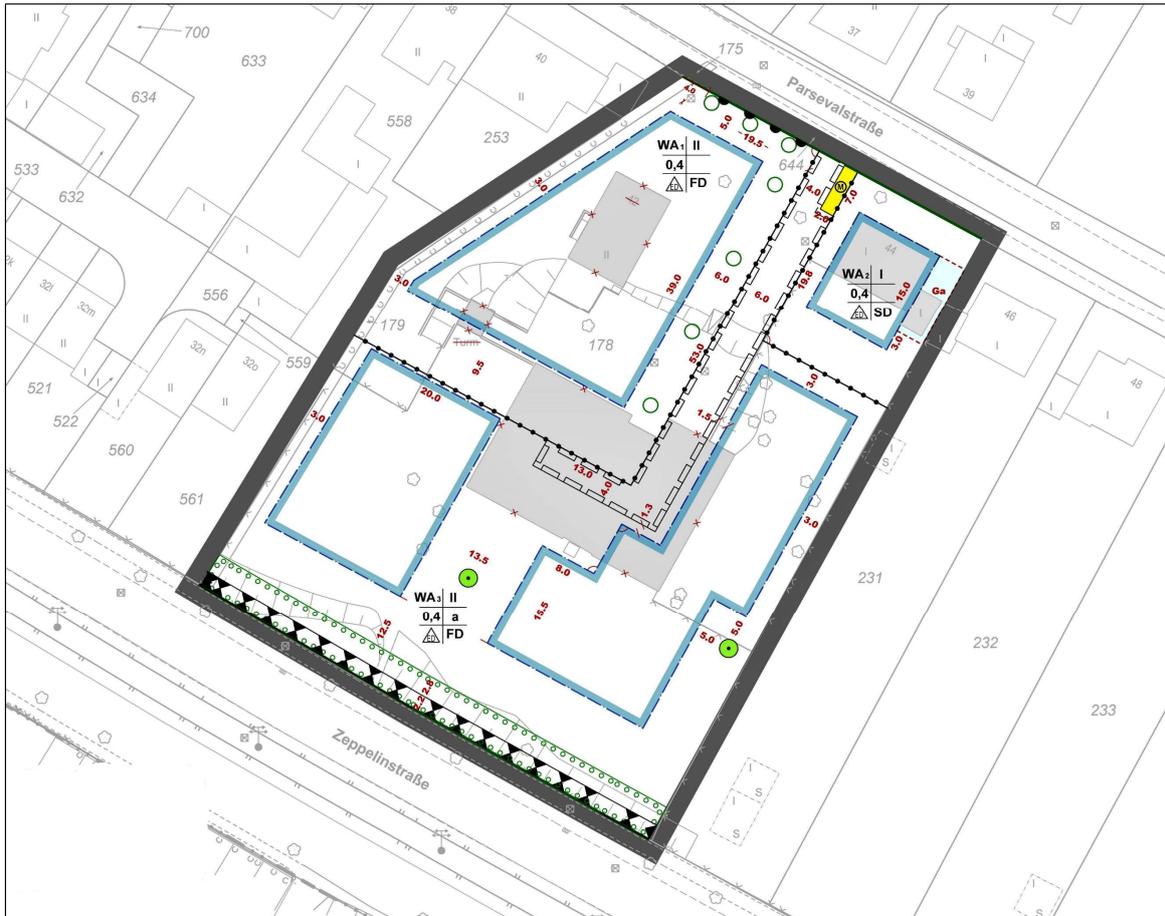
Bebauungsplan (Planung Stand 29.01.2021, Stadt Mülheim an der Ruhr)
